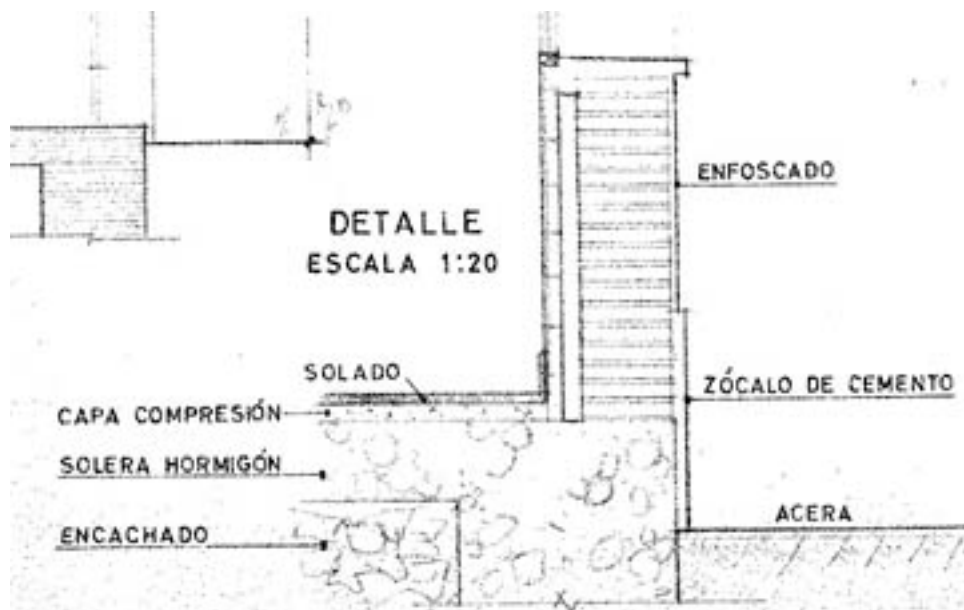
Detalle de fachada y forjado sobre terreno. Fuente: Archivo de la Villa de Madrid.
